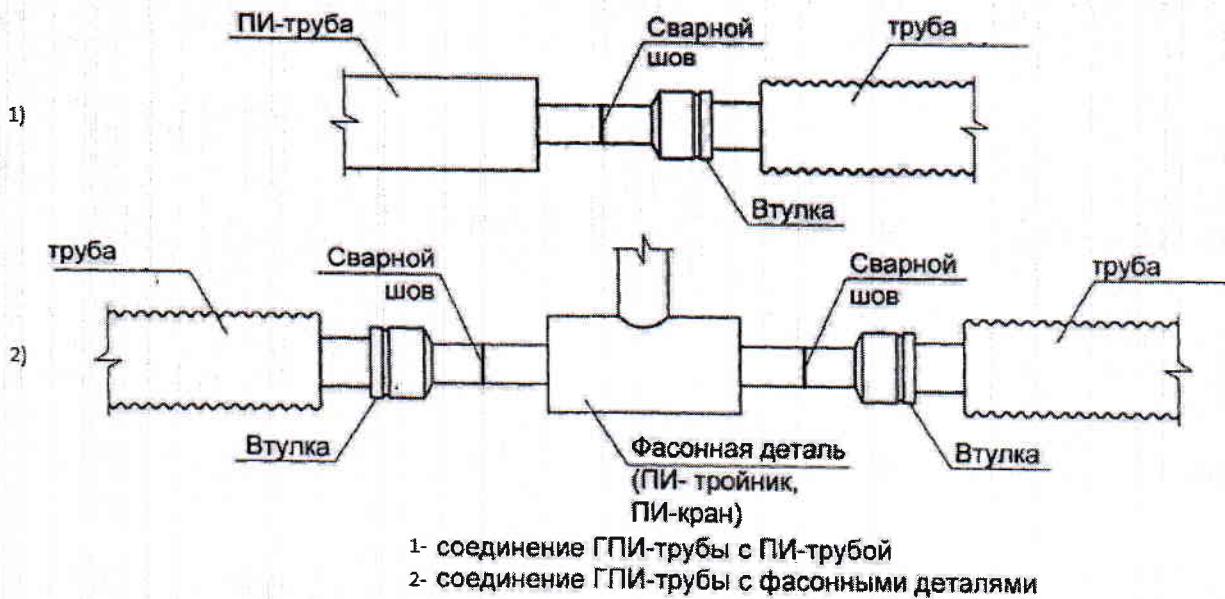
Варианты соединения труб ГПИ с установкой втулки
